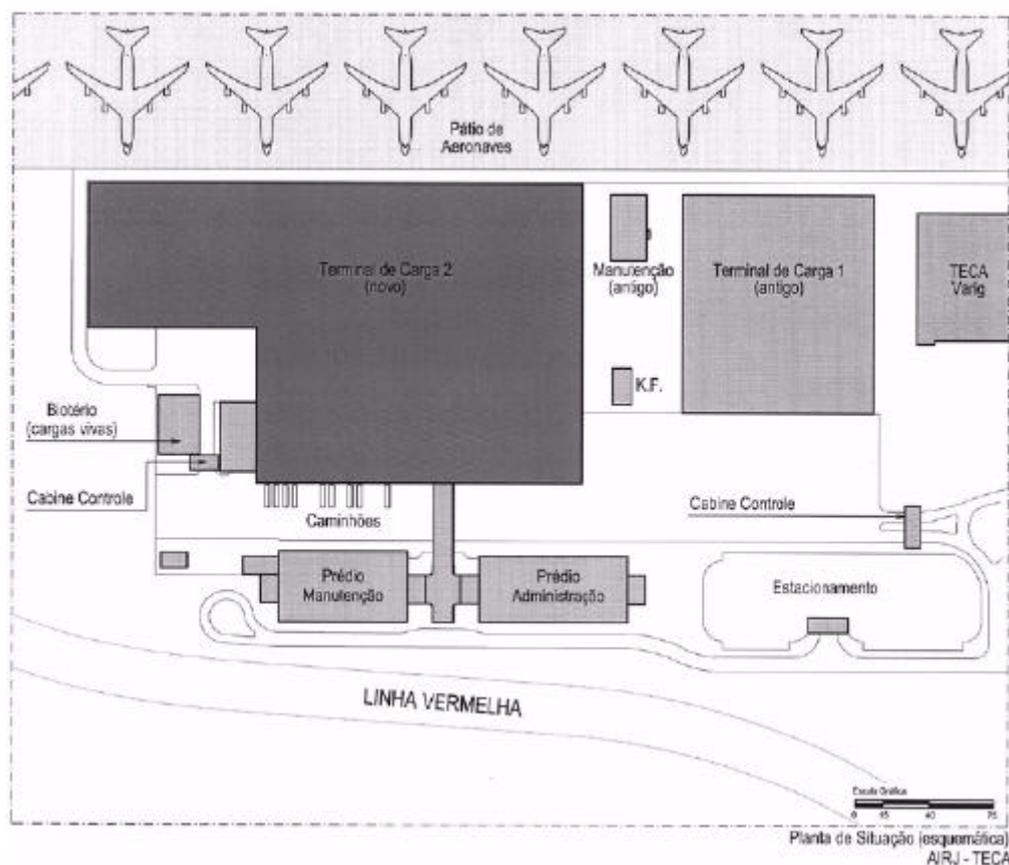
Planta Baixa Localização do Sistema de Carga Aérea da INFRAERO
